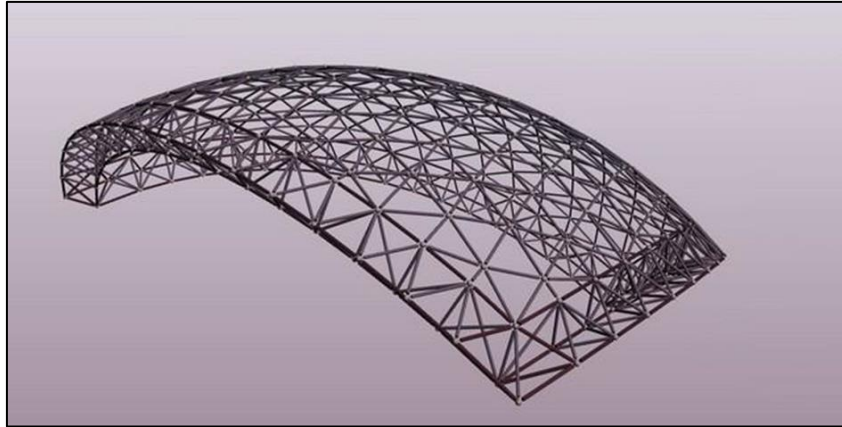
Toiture tridimensionnelle Source : http://img.archiexpo.com/images_ae
